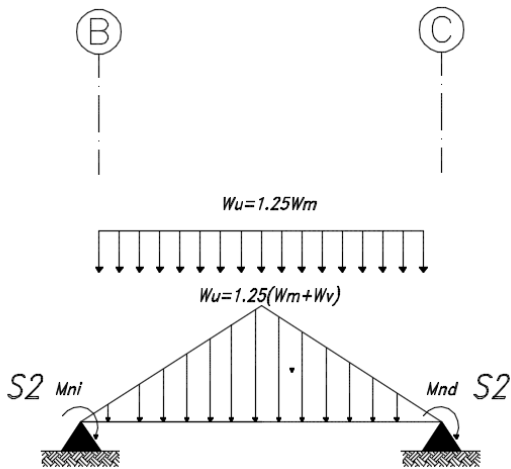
Cargas en la viga entre los ejes "B-C".
